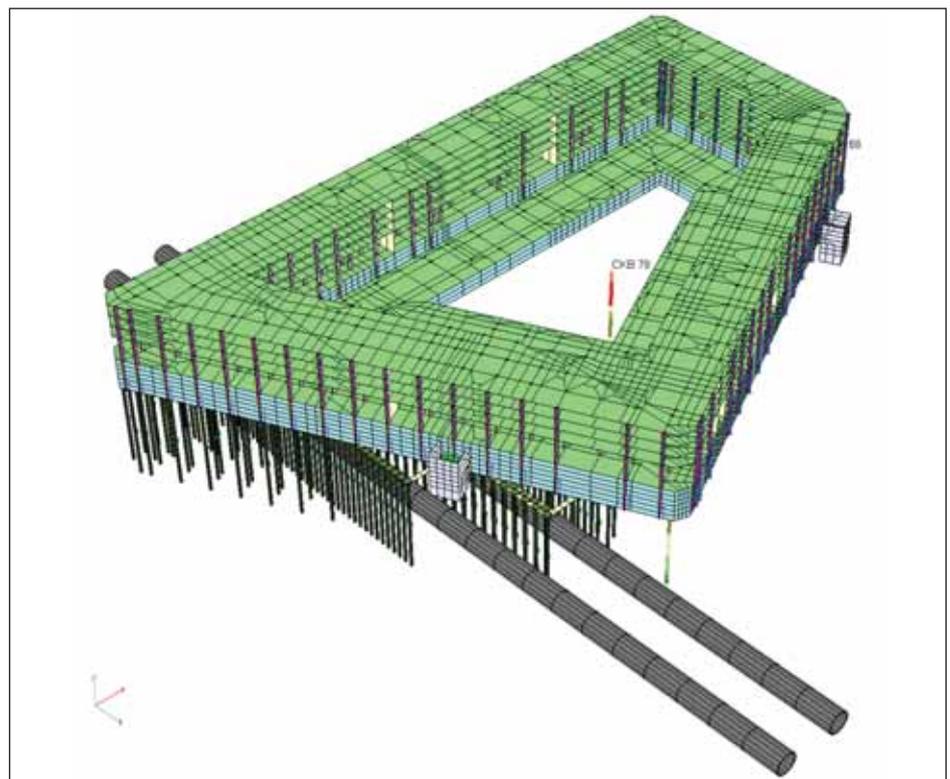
Фрагмент расчетной схемы со свайно-ростверковым основанием
